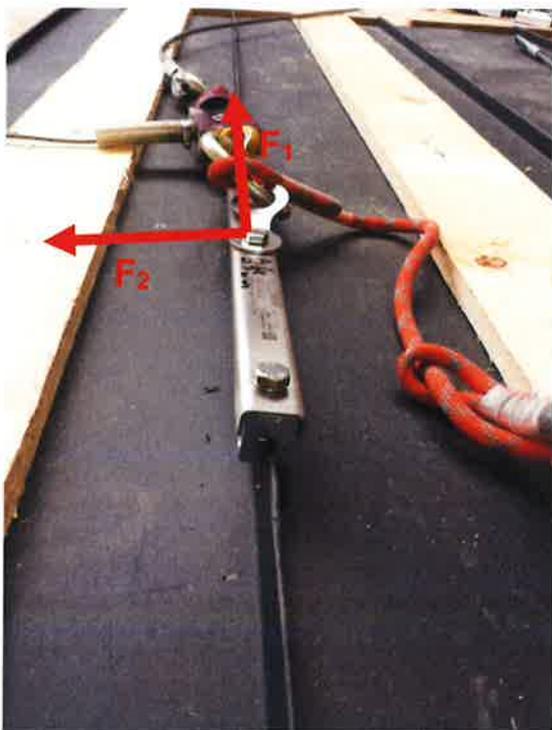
Anschlagereinrichtung, Typ: ABS-Lock® Falz V mit Profilklemmen für Rundbördelprofile (Montagebeispiel)
